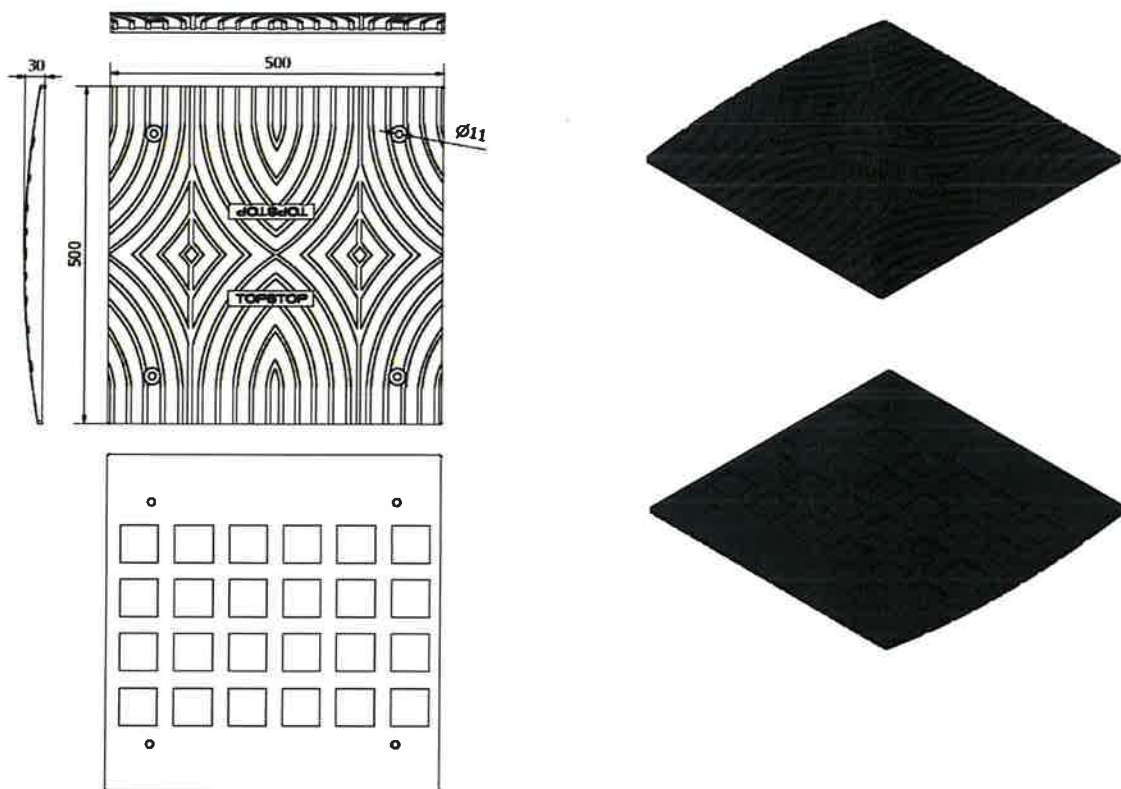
Element podstawowy progu podrzutowego PpVB-5/60
